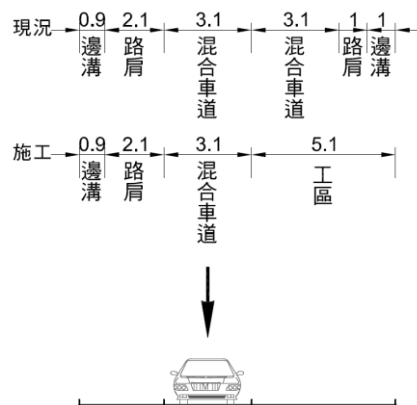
民國路 U 型溝施工斷面配置示意圖
